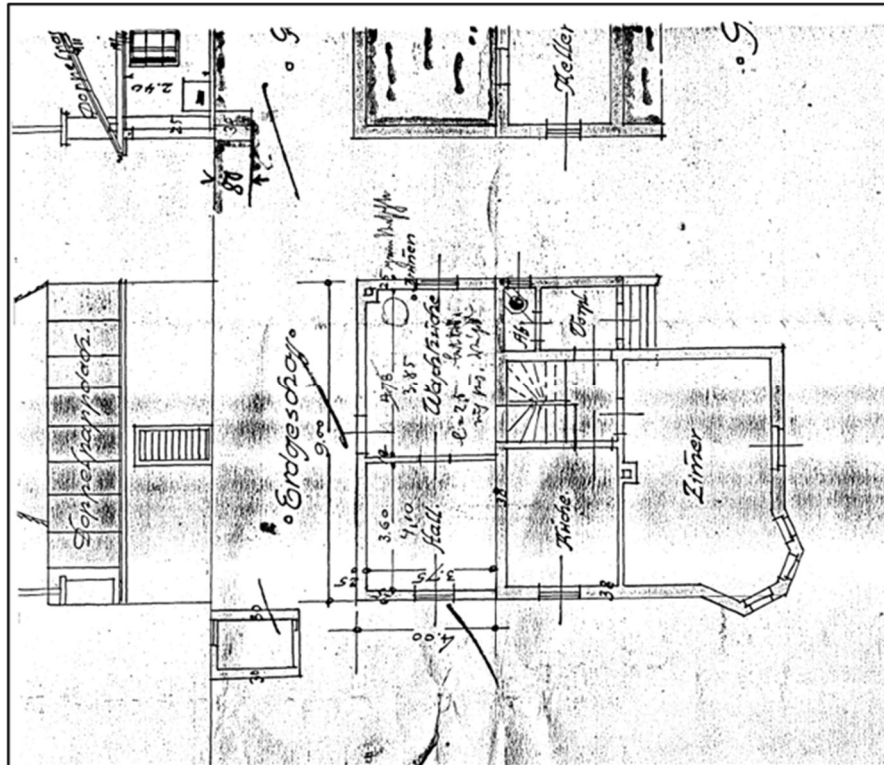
Grundriss (Erdgeschoss) des Hauses mit der Zeitangabe „Riem im März 1922“
